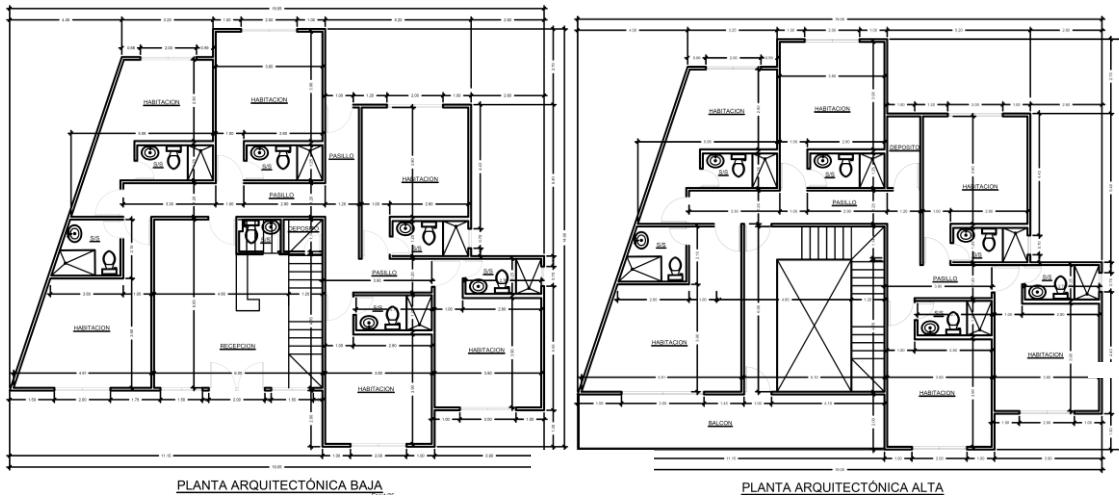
Distribución del edificio por planta (Izq. Planta Baja, Der. Planta Alta).
